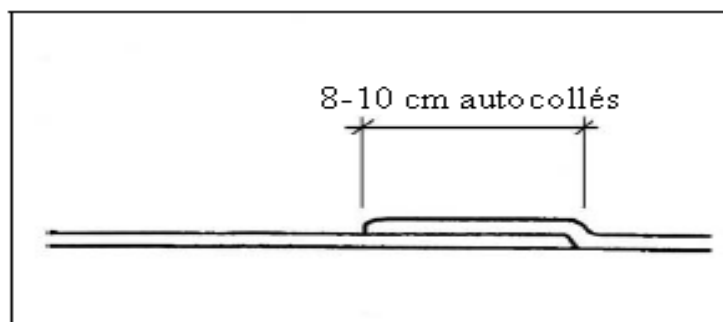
Recouvrement longitudinal par autoadhésivité sur toute la largeur du recouvrement ≥ 8 cm, des feuilles ESTERDAN 30 P ELAST S ou POLYDAN 180-30 P ELAST S
